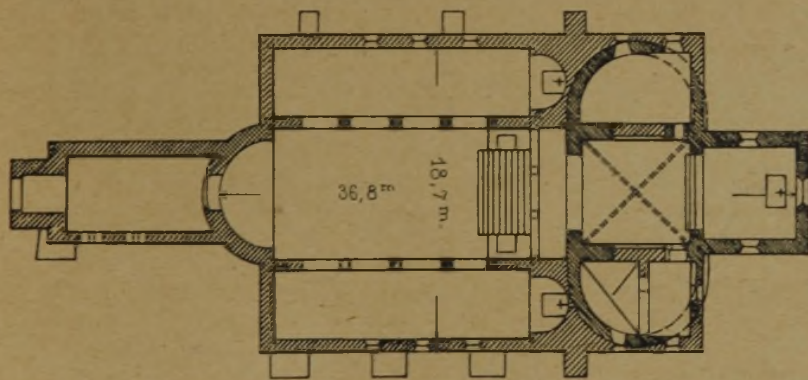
Grundriß der Stiftskirche St. Georg (nach Adler).
